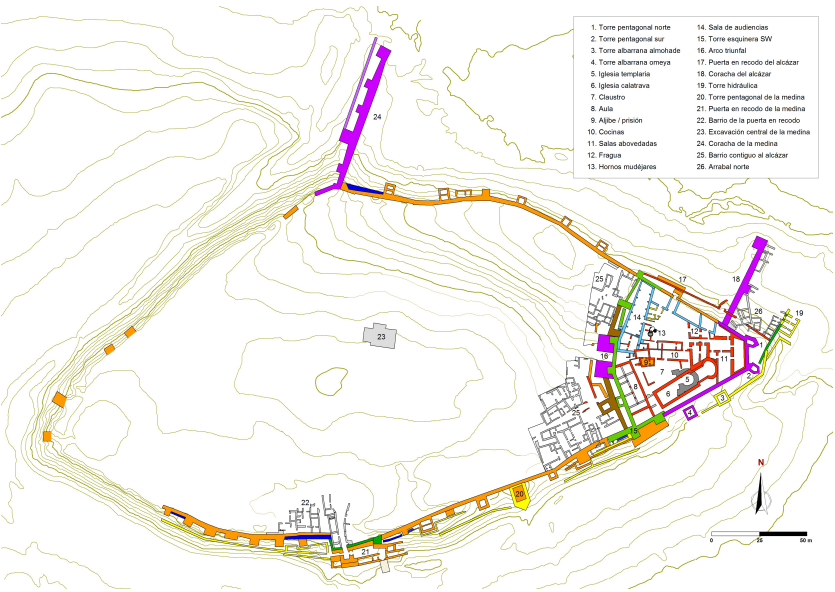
Plano del recinto amurallado (Archivo de Calatrava la Vieja)
